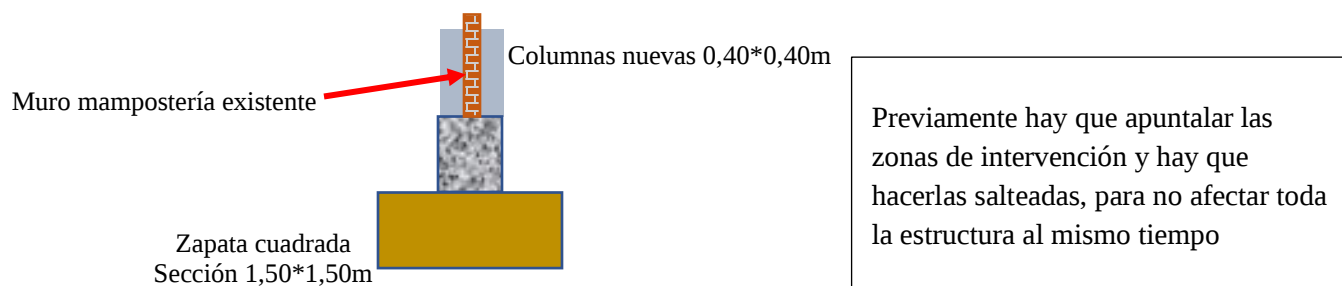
Corte Transversal Detalle Refuerzo con zapata y pórtico
